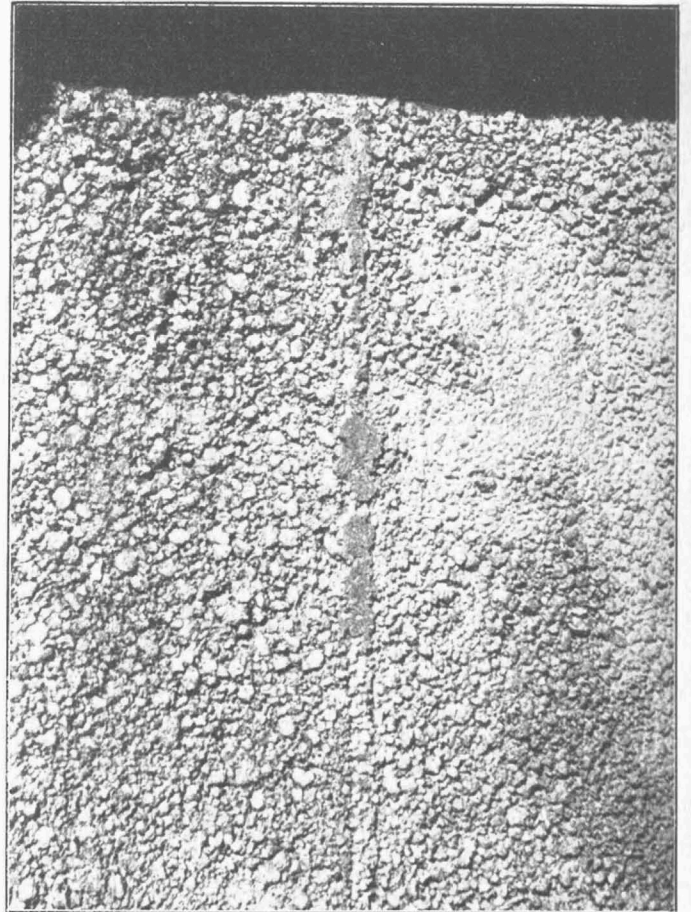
Ansicht einer unbearbeiteten Stoßfuge
